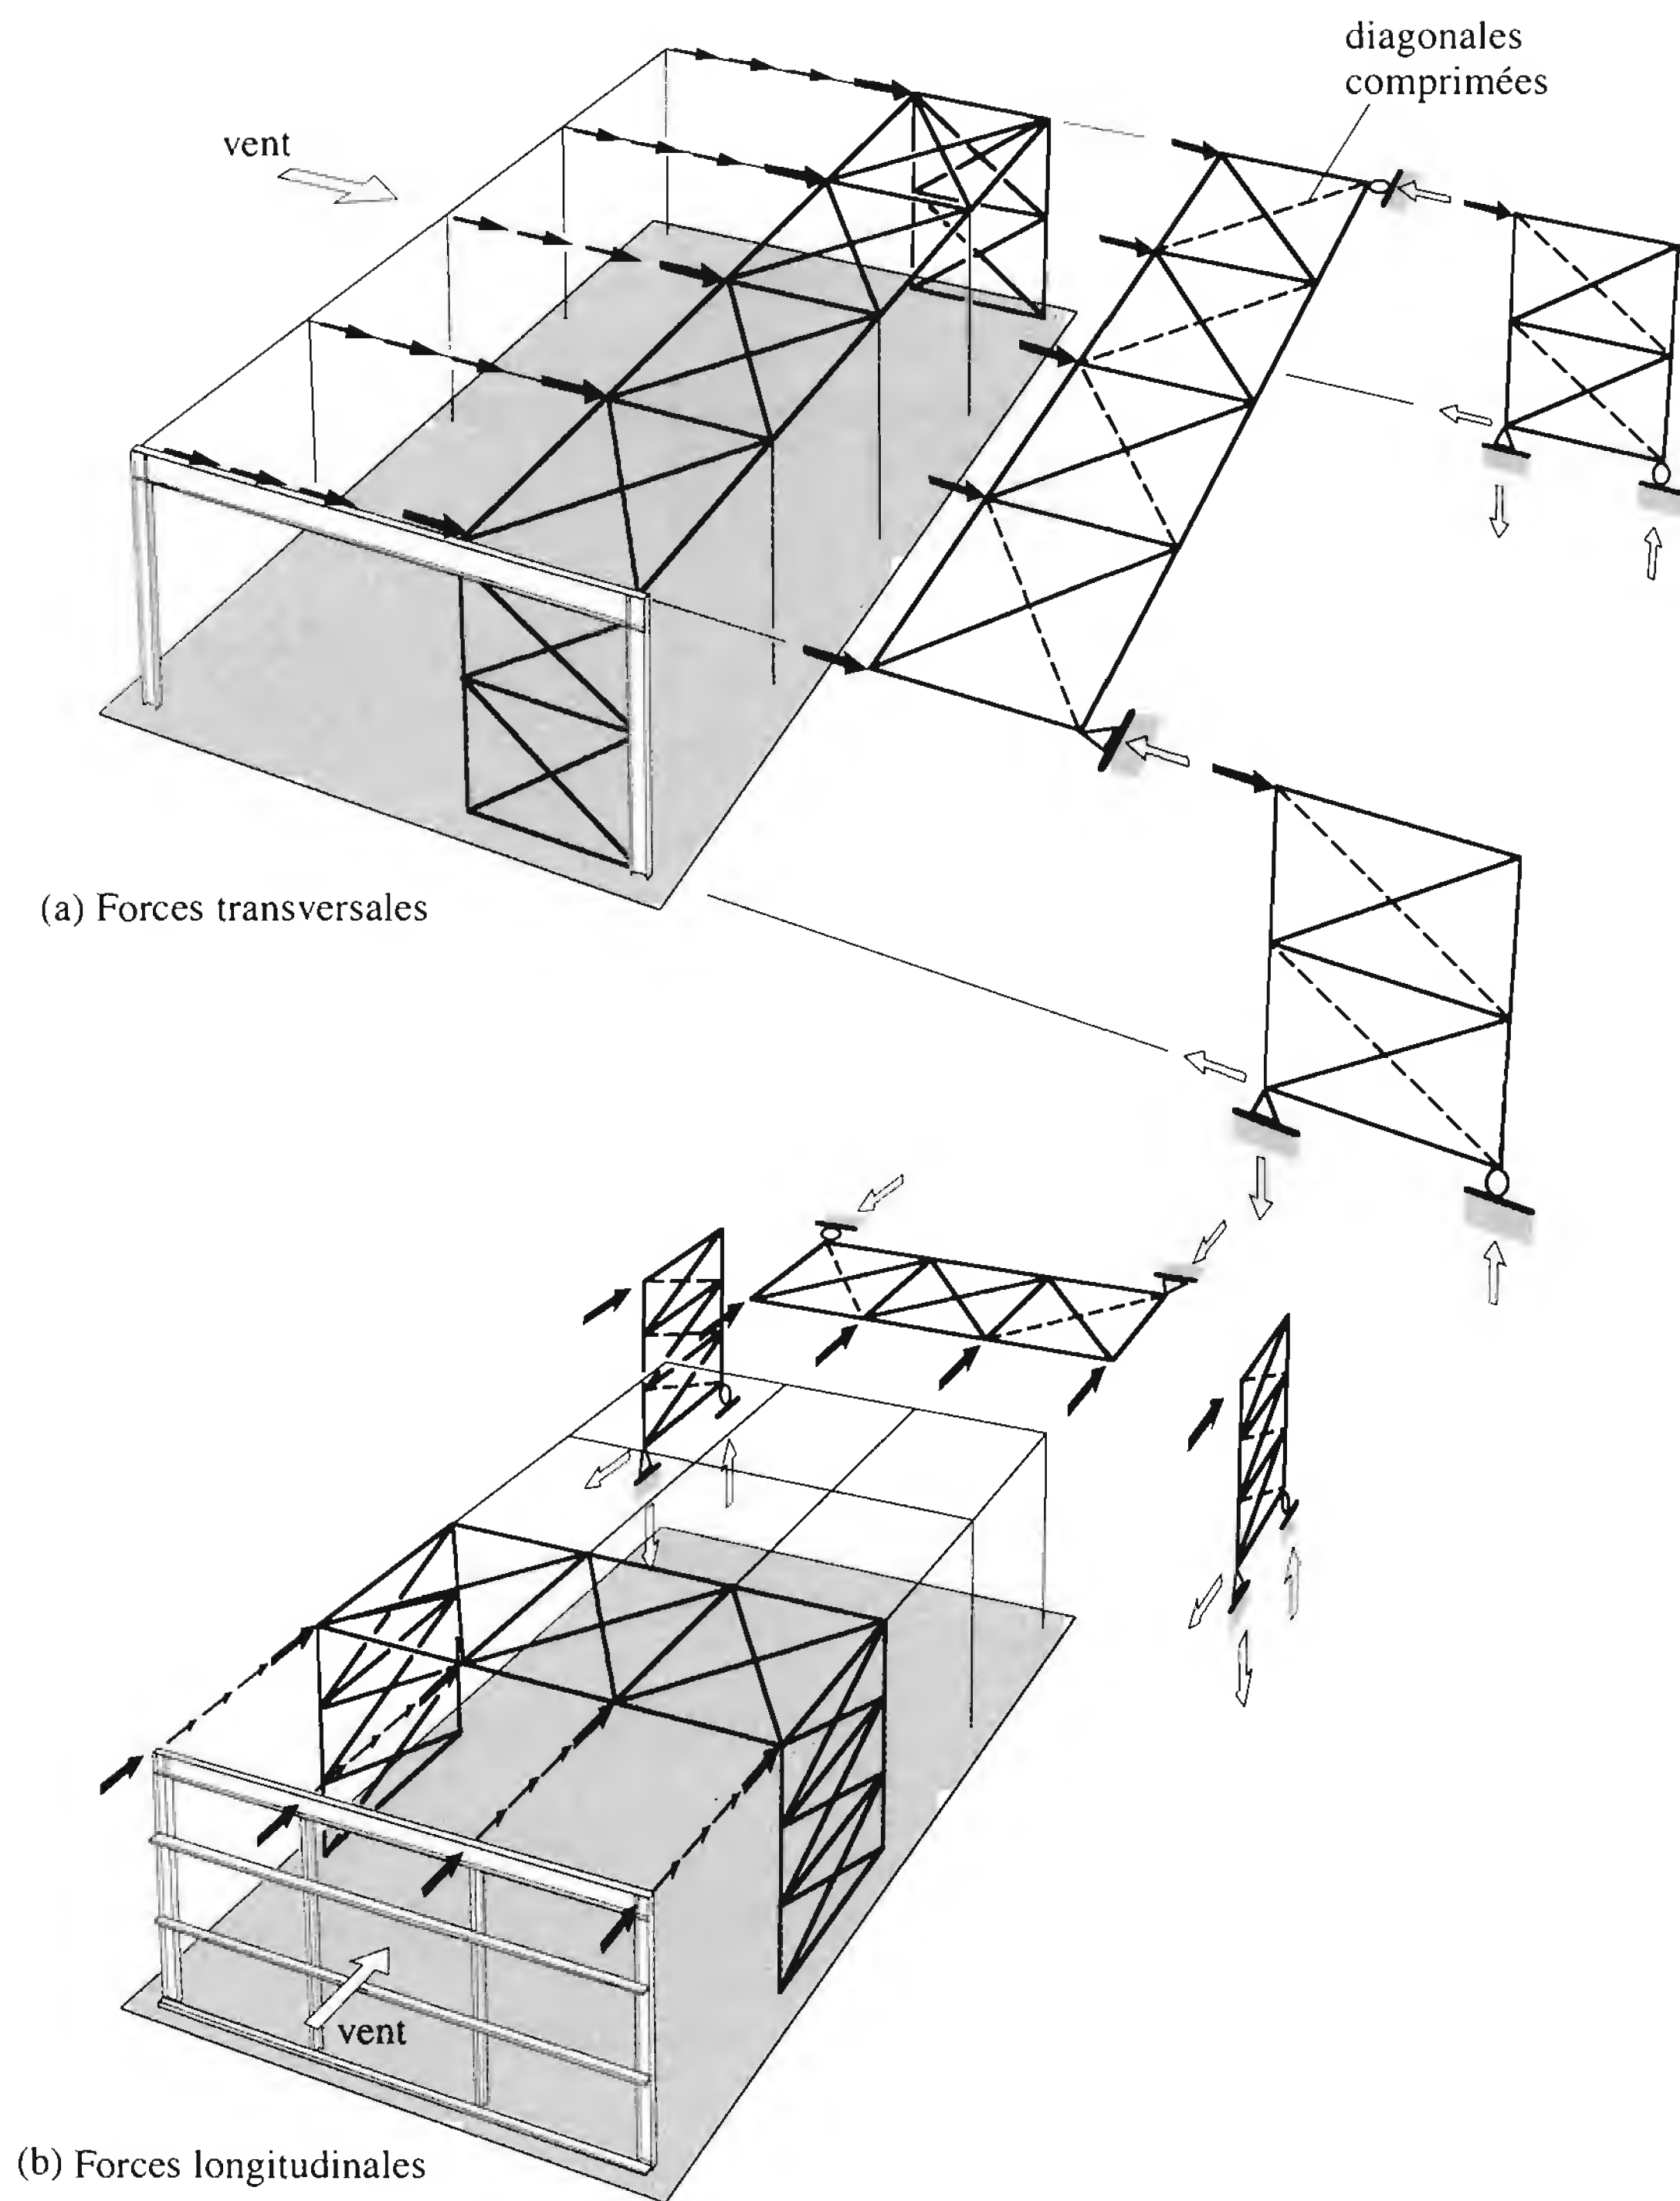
Cheminement des forces transversales et longitudinales dans le cas d'une halle à toiture horizontale.
